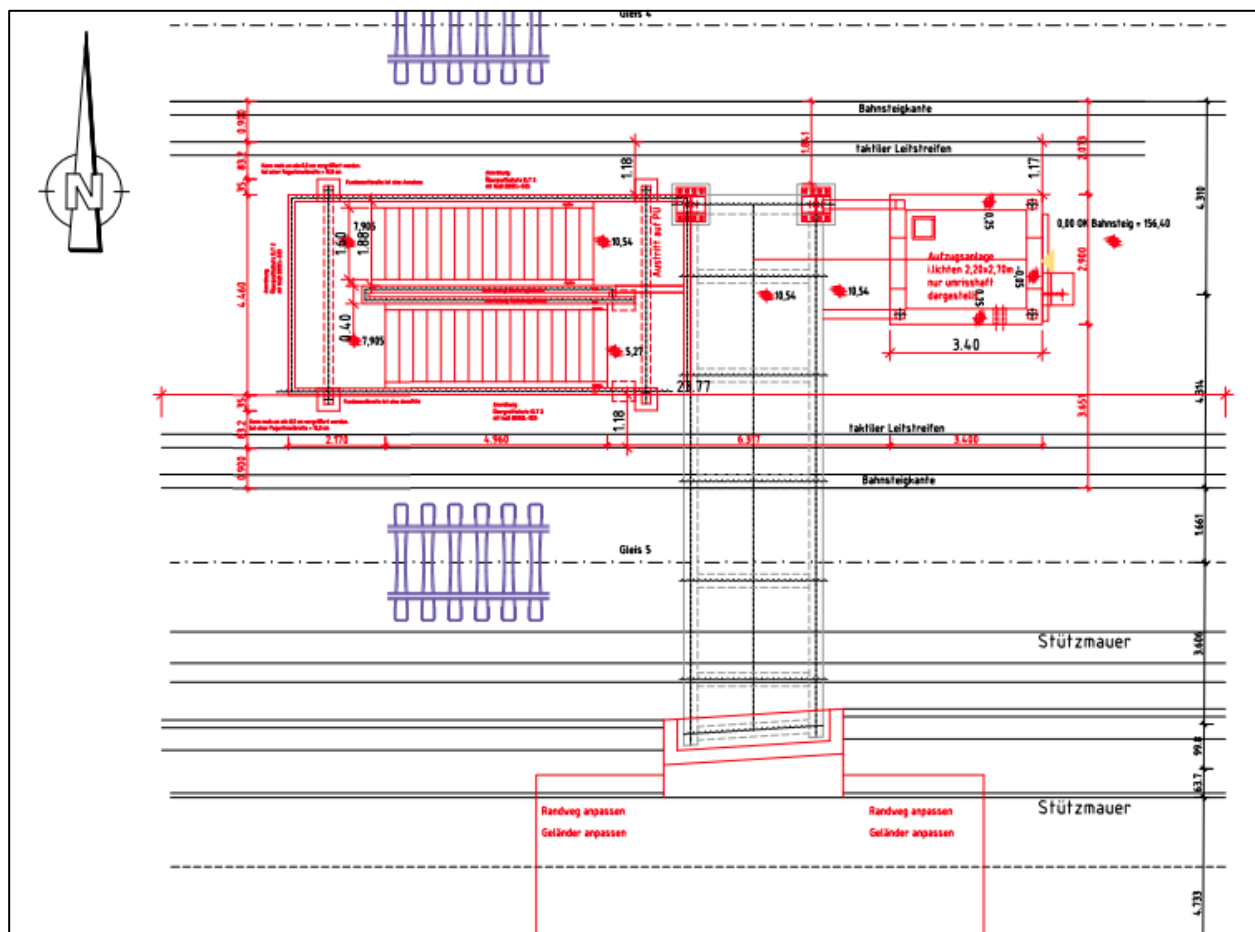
Grundriss des geplanten Aufzugs, Blick von oben (DB InfraGO, 2024).
